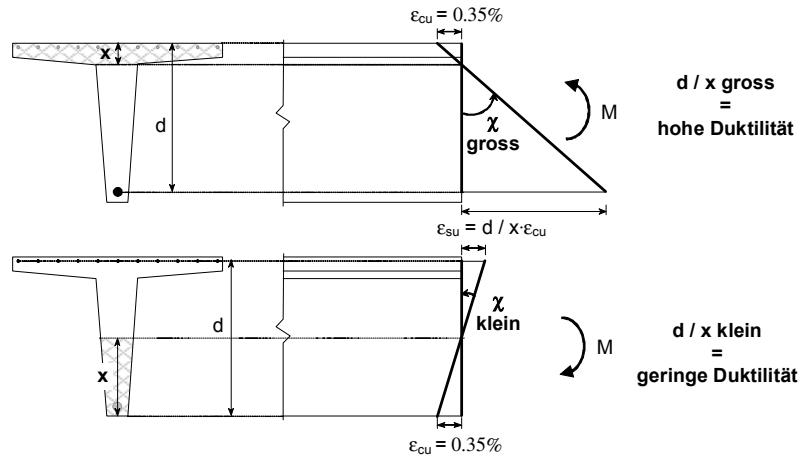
Duktilität eines Biegeträgers aus Stahl- / Spannbeton
